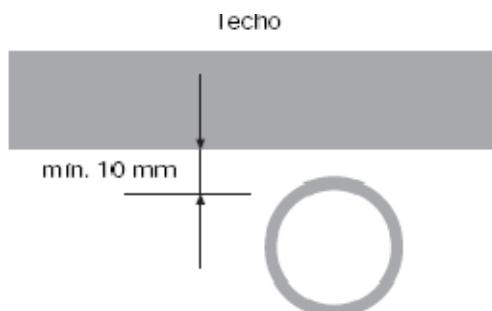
Distancia entre tubería de gas y techo.
